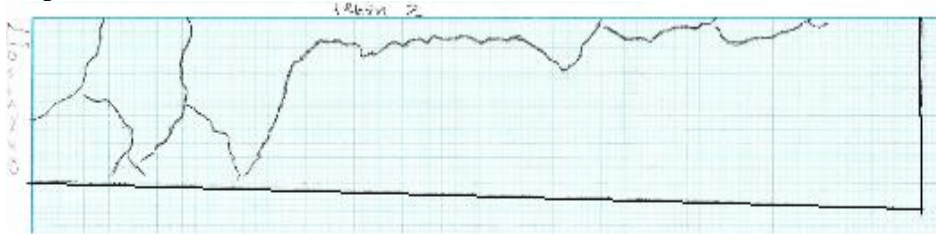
Penurunan permukaan blok beton benda uji KT-SC-01
